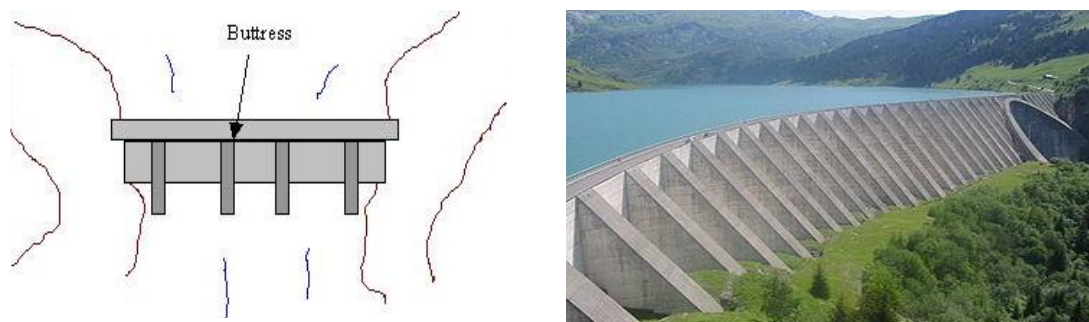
Barragem de contrafortes. Vista em planta e barragem de Roselend, França (Fonte: <http://en.wikipedia.org>).
